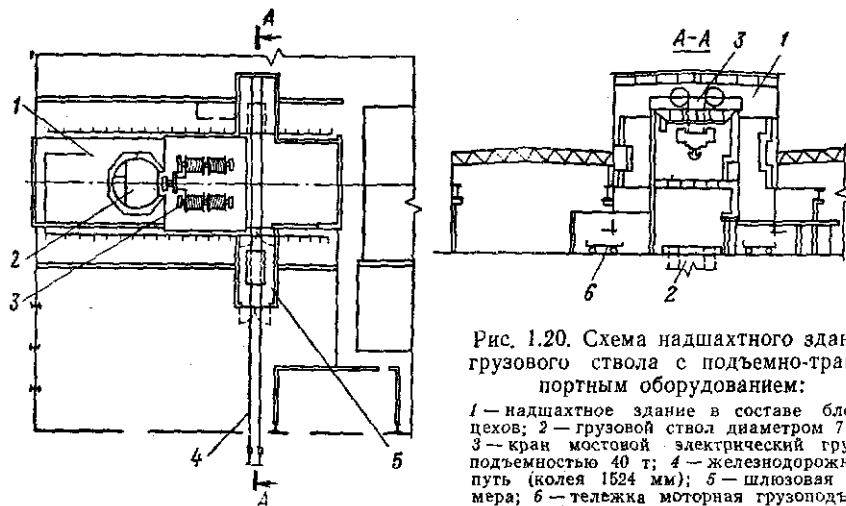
Схема надшахтного здания грузового ствола с подъемно-транспортным оборудованием:
